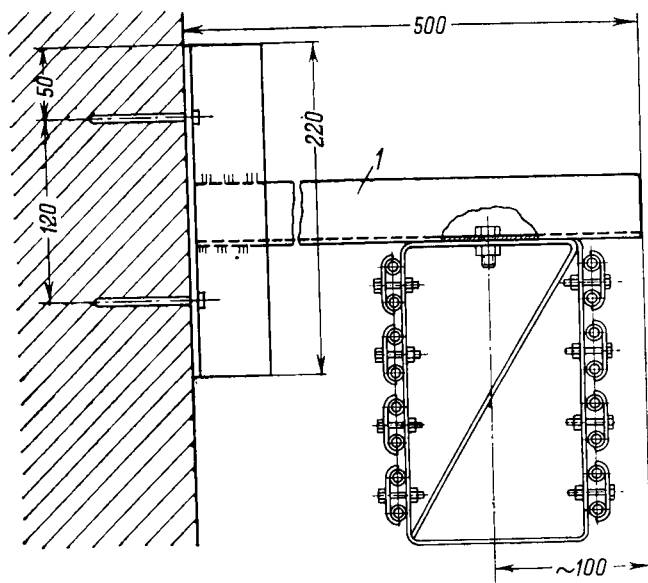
Крепление бескаркасного блока труб к вертикальной стене.
